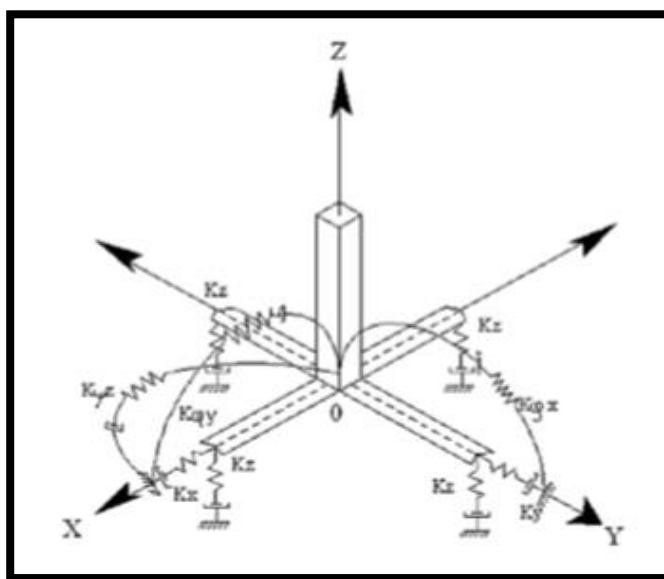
Esquema espacial de cálculo de la cimentación tipo zapata aislada.
